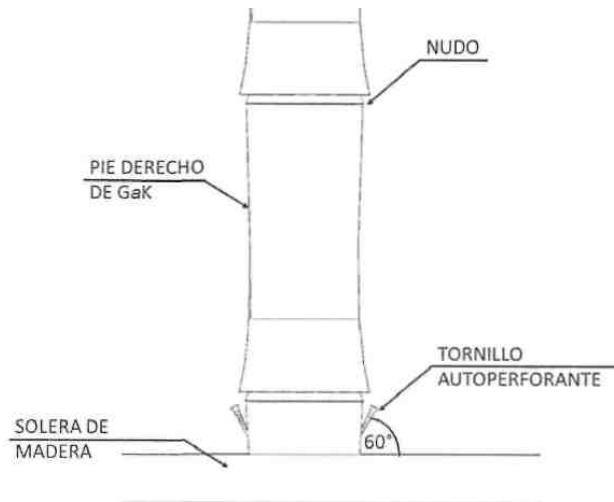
Detalle de unión de la columna de GaK a la solera de madera
